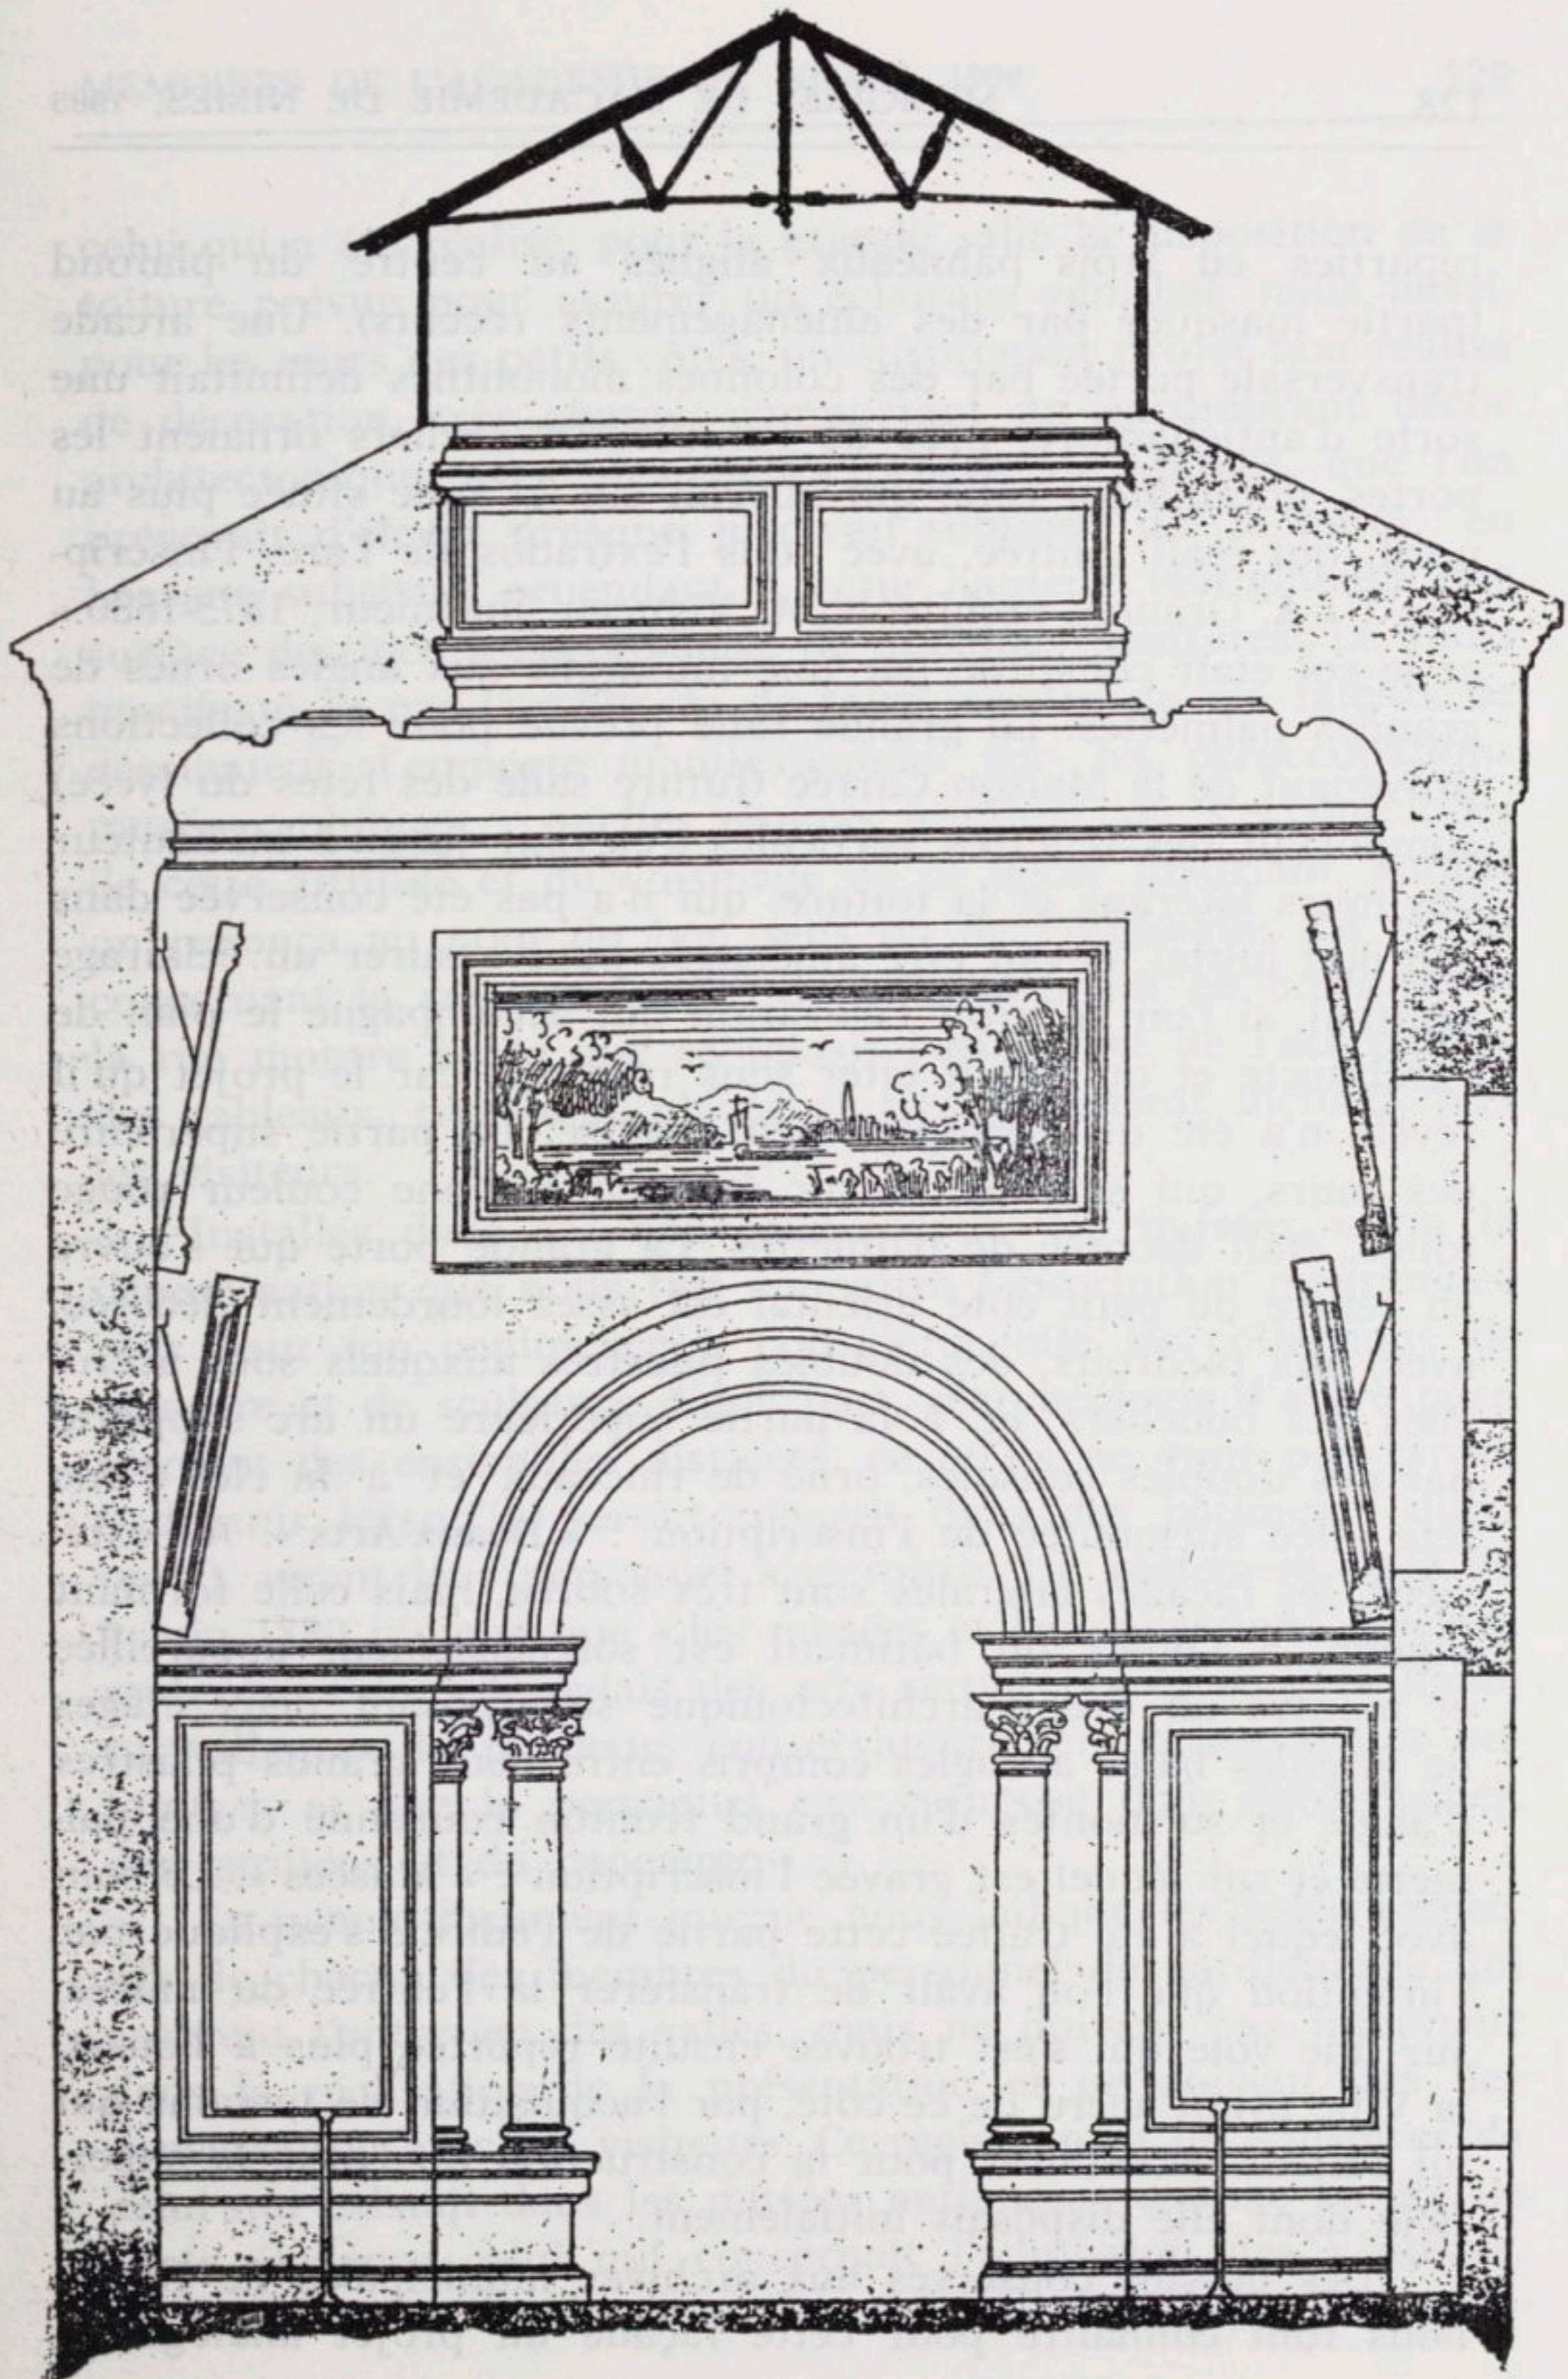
Le Palais des Arts. Coupe transversale du bâtiment sur le boulevard Saint-Antoine (Archives municipales de Nîmes).
